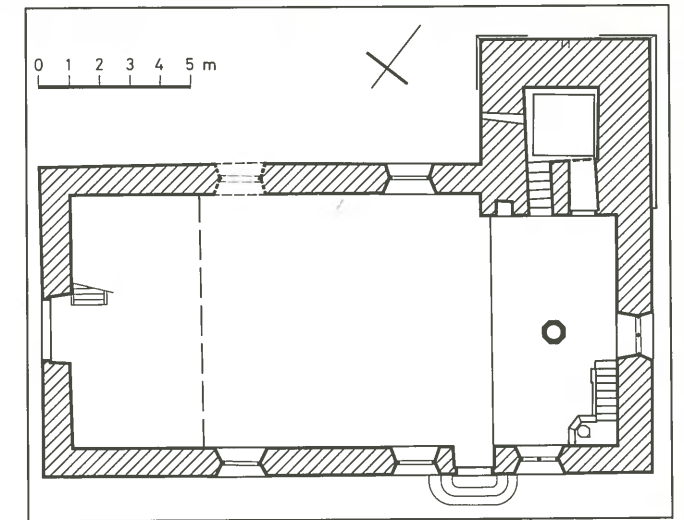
Rekonstruierter Grundriss der Kirche nach dem Umbau des 17. Jahrhunderts, Mst. 1:250.
